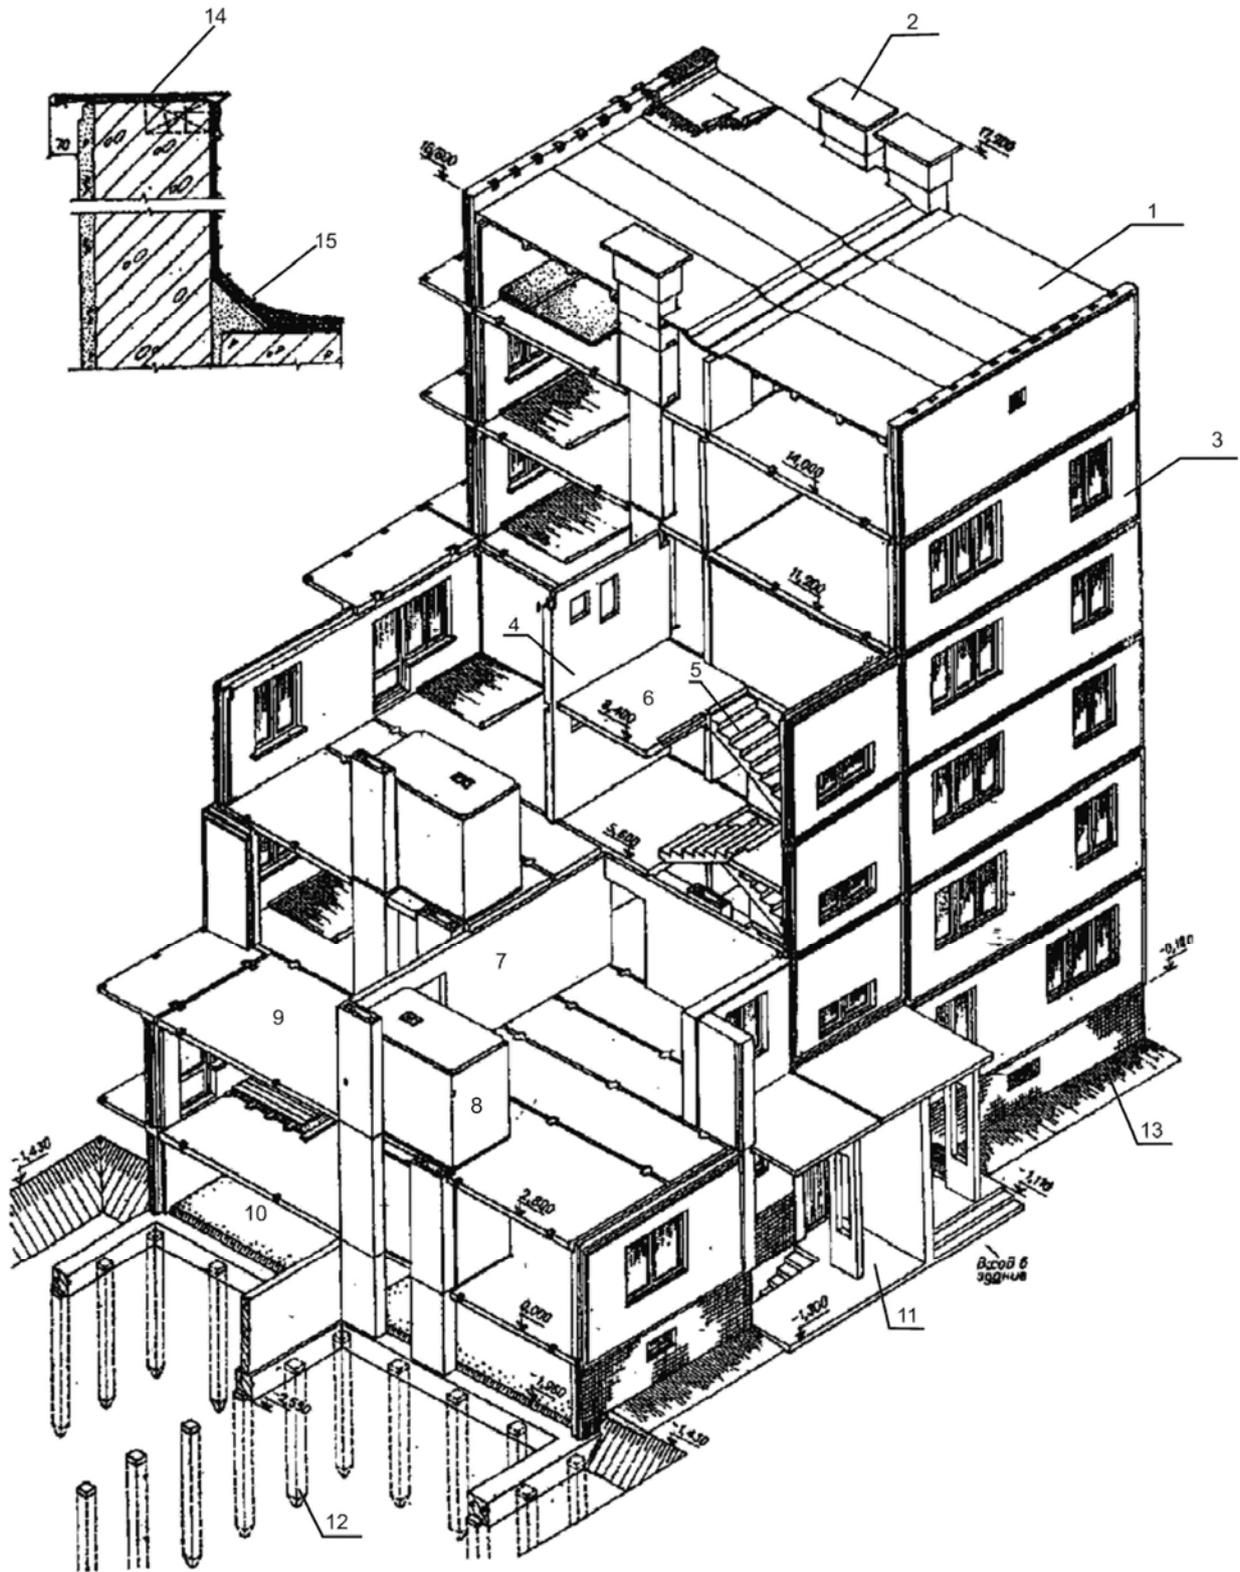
Пространственный разрез многоэтажного здания с панелями на две комнаты по горизонтали: 1 — ж/б ребристая плита покрытия; 2 — вентиляционный блок; 3 — наружная стенная панель; 4 — электротехническая панель; 5 — лестничный марш; 6 — лестничная этажная площадка; 7 — ж/б панель внутренних стен; 8 — санитарно-техническая кабина; 9 — ж/б плита перекрытия; 10 — уплотненный грунт; 11 — вход в камеру мусороудаления и спуск в подвал; 12 — свайный фундамент; 13 — отмостка; 14 — фартук из ковanej стали; 15 — три слоя рубероида
